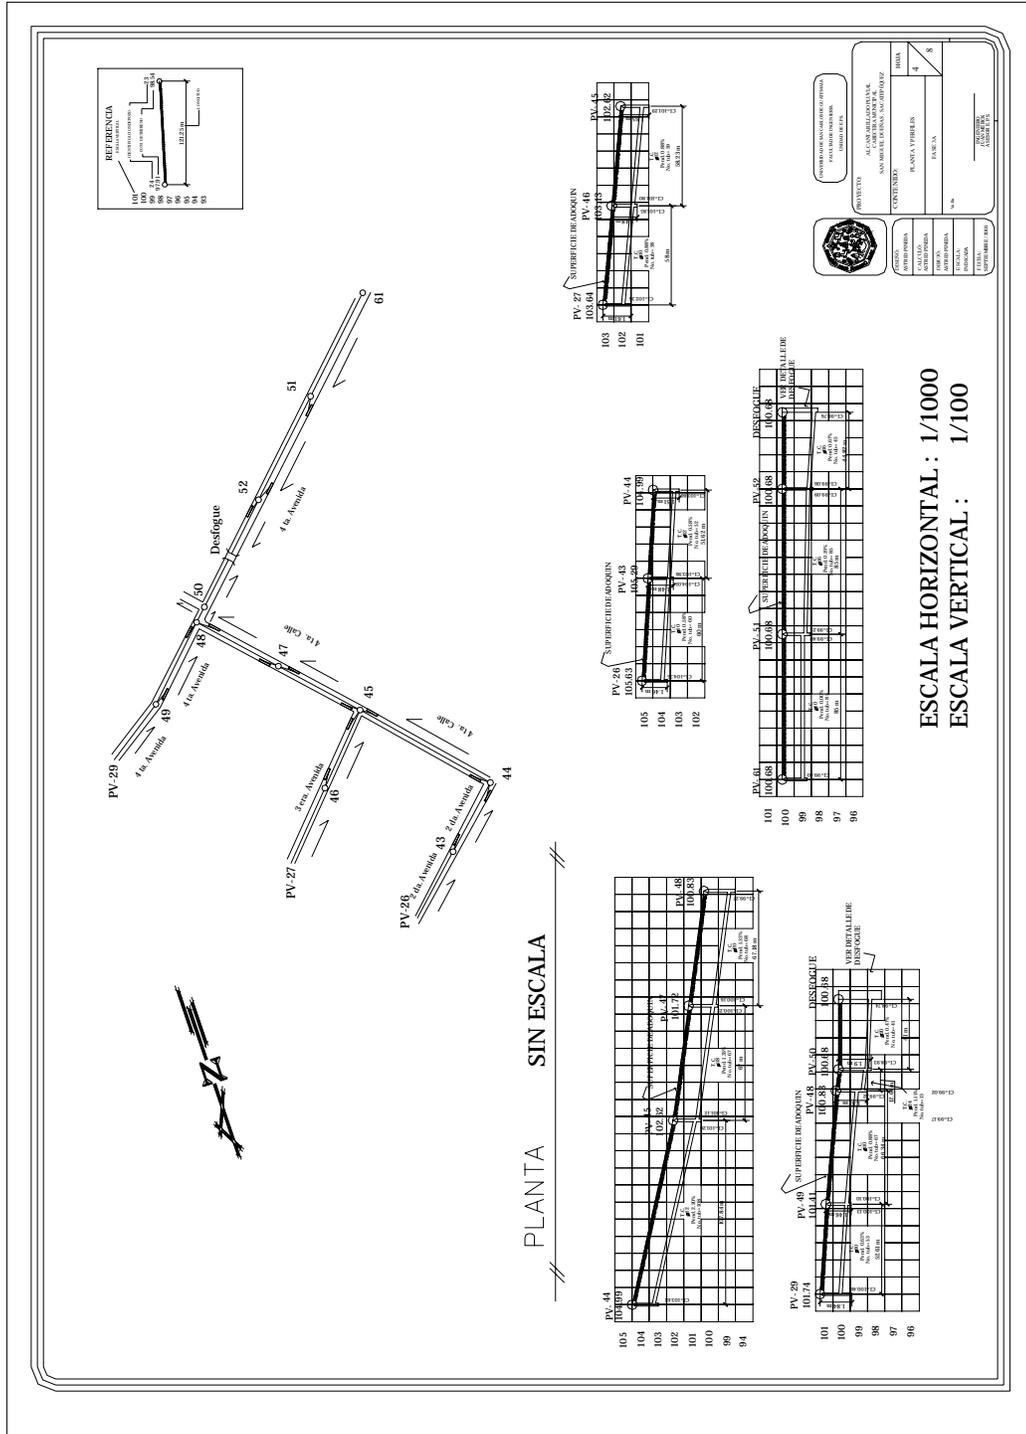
Planta y perfiles fase tres “b” alcantarillado pluvial
